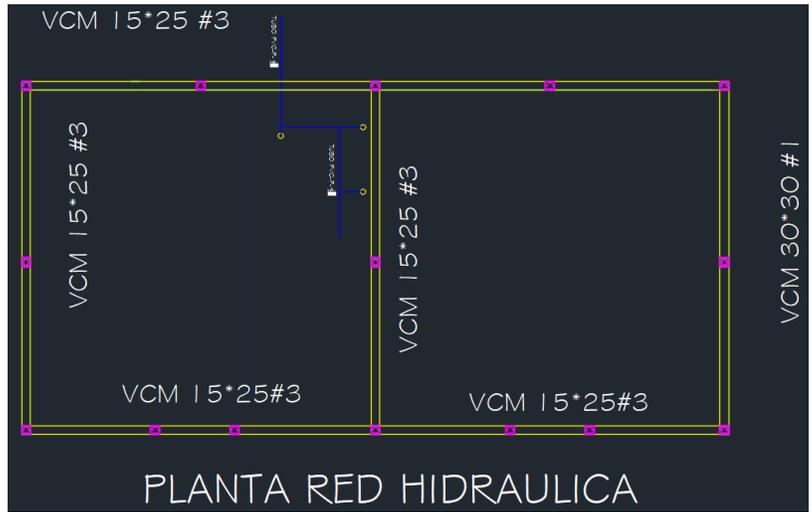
Planta red Hidráulica Fuente: Elaboración propia
